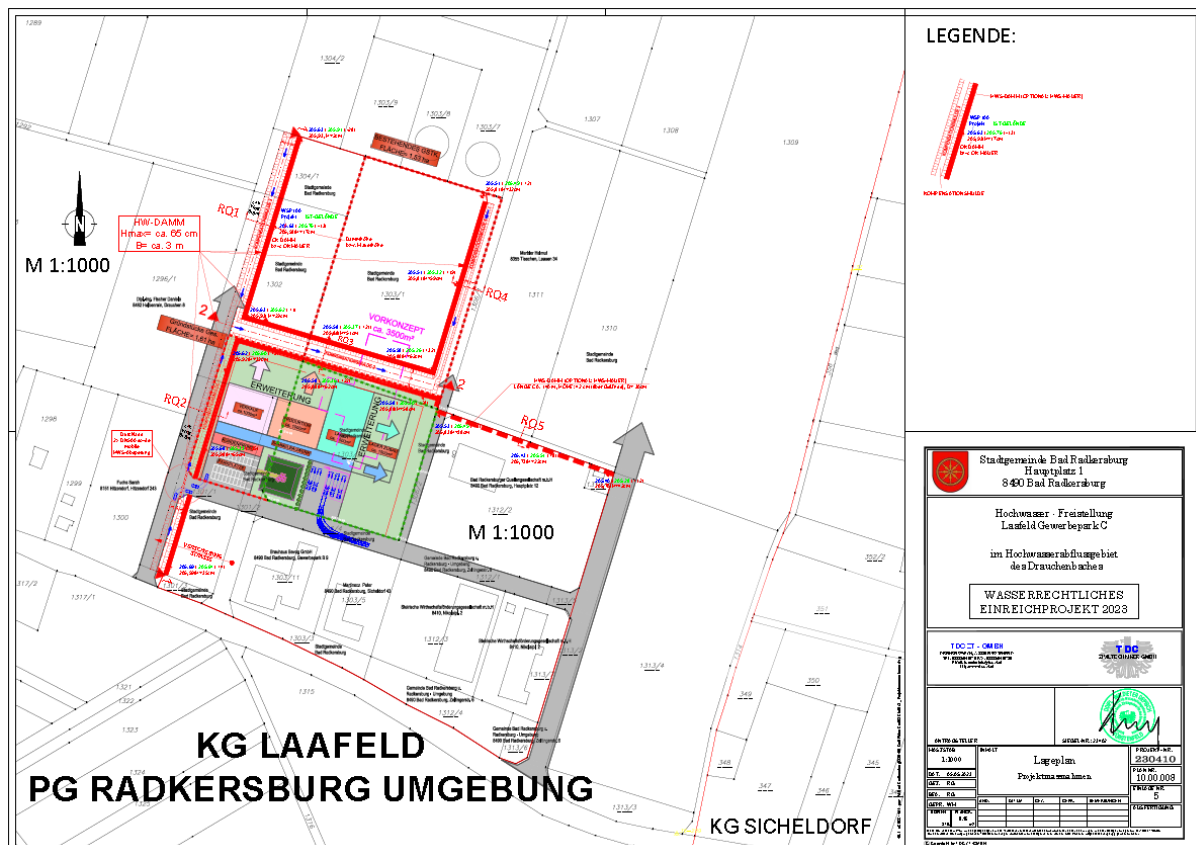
Lageplan zum wasserrechtlichen Einreichprojekt (o.M., Stadtgemeinde Bad Radkersburg / TDC ZT GmbH)
